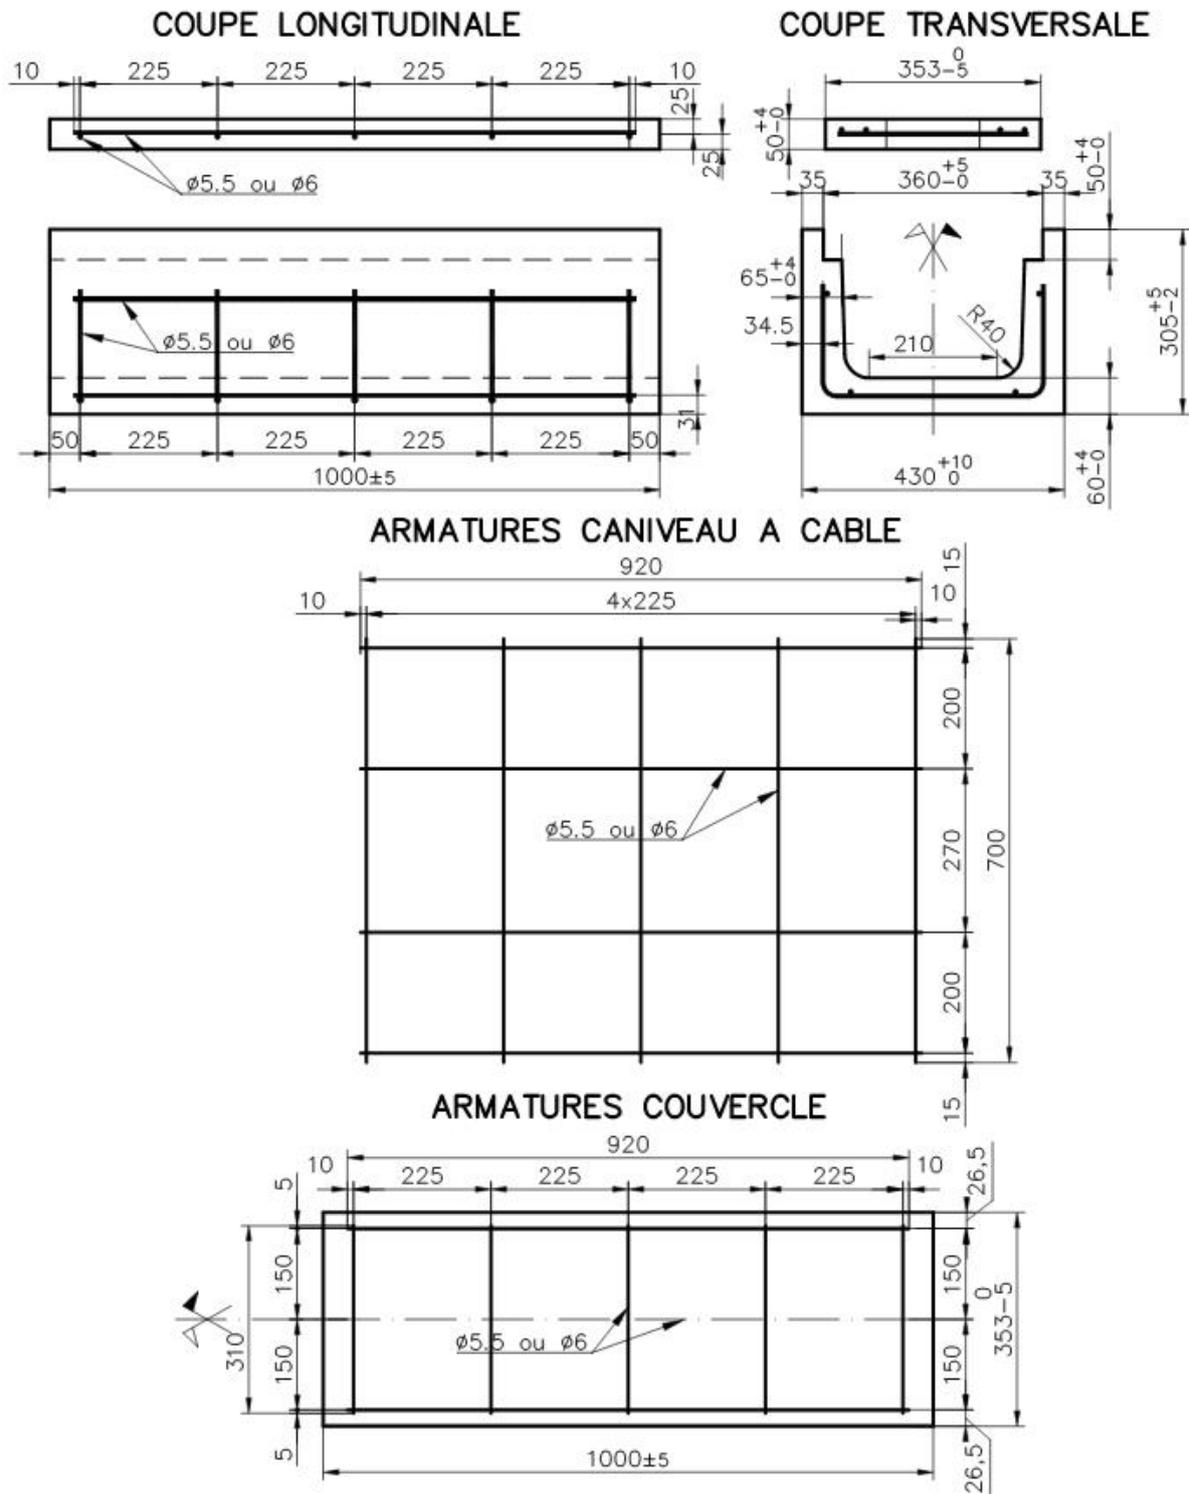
caniveau à câbles standard modèle 30 avec couvercle encastré (dimensions en mm)
